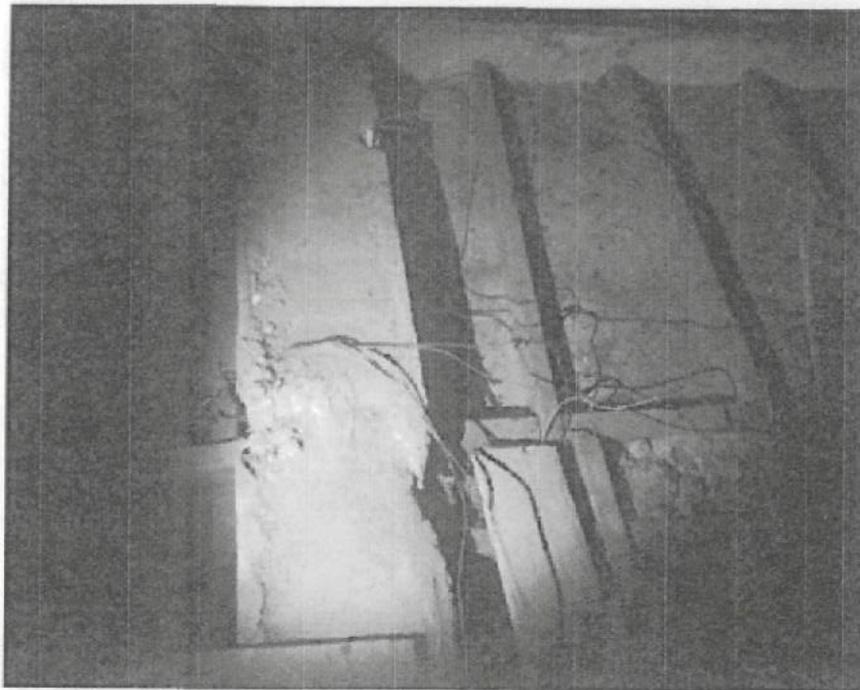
VISTA DE CONEXIONES ELÉCTRICAS INESTABLES
